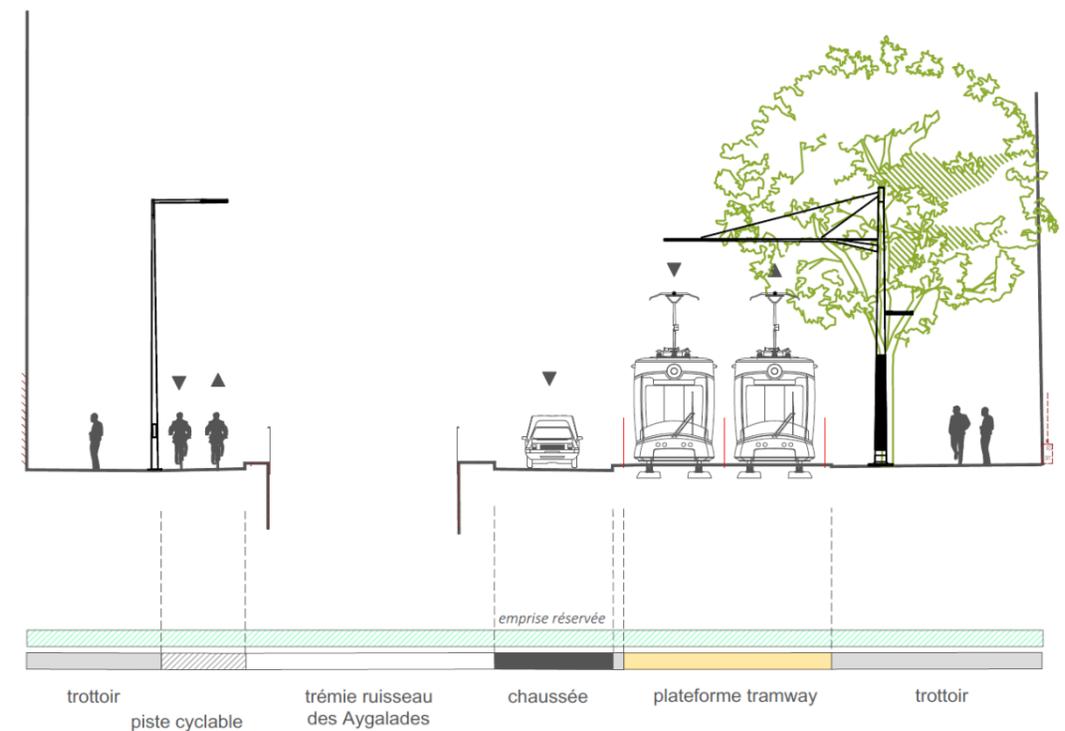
exemple de profil en travers sur le boulevard de Paris
